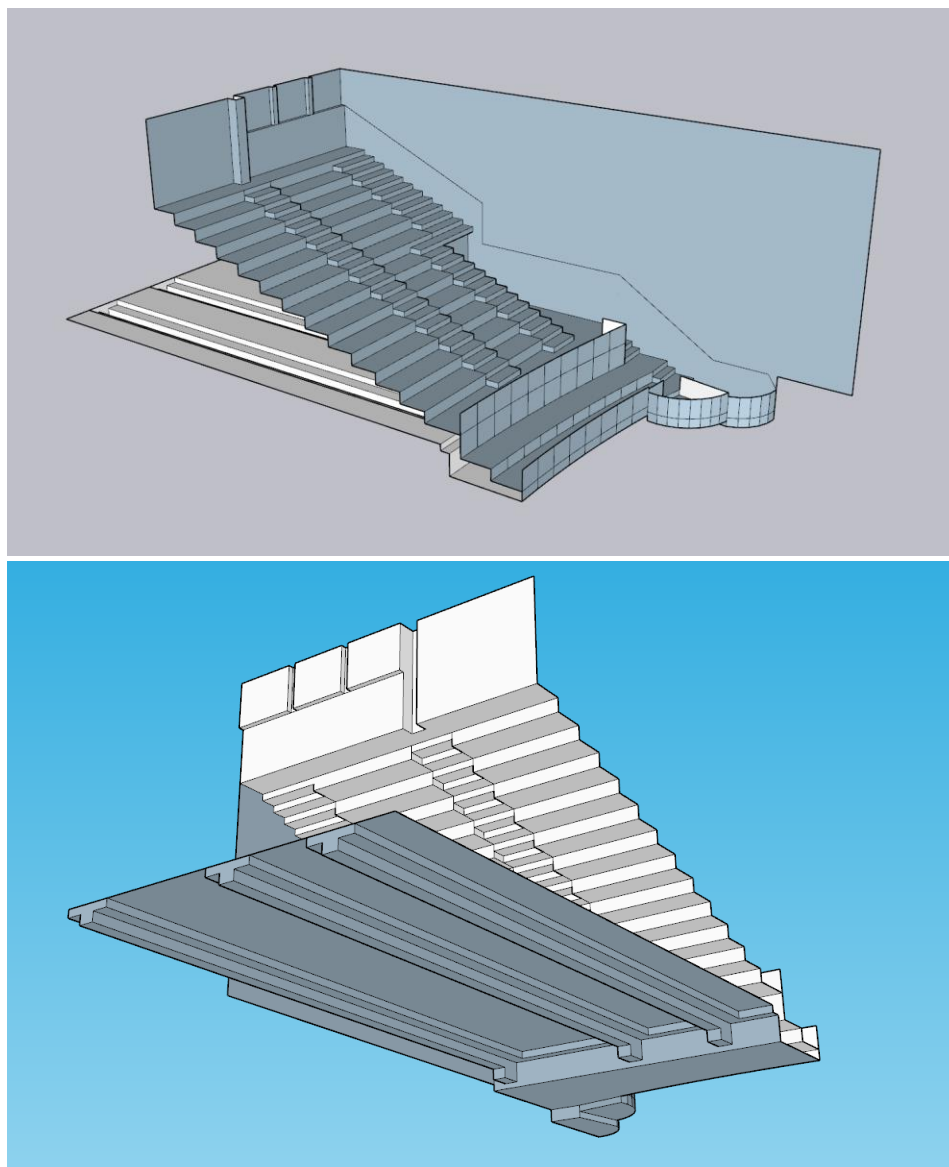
Construcción del suelo de platea y escenario y levantamiento de paredes
